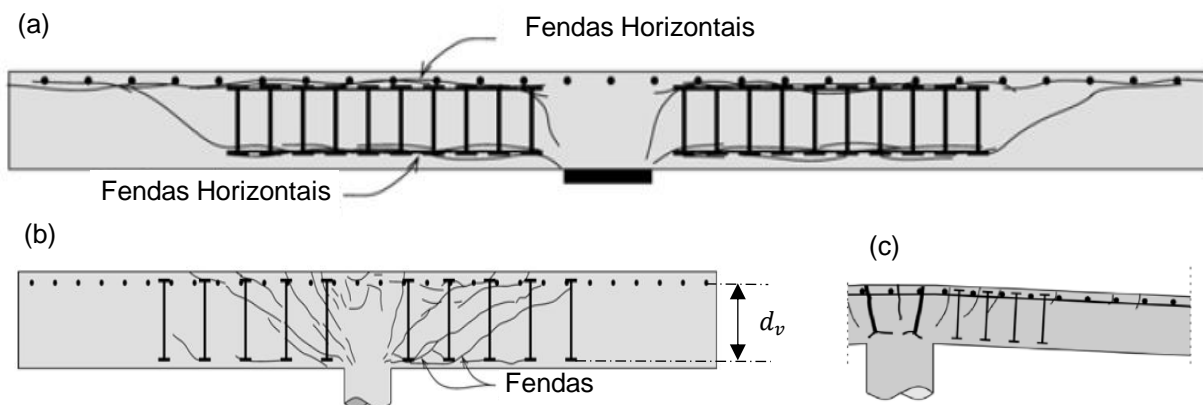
Modos de rotura que dependem de regras construtivas: (a) Delaminação do recobrimento do betão; (b) Arrancamento das ancoragens das armaduras transversais; (c) Flexão (adaptado de [18] e [24])
